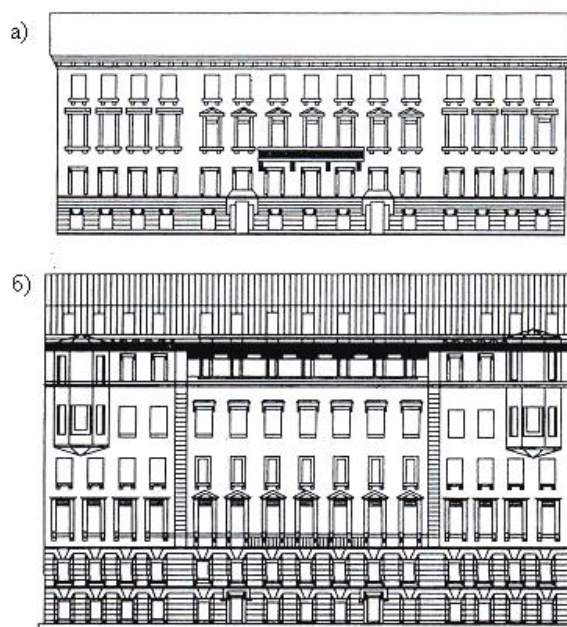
Фасады реконструируемого здания до надстройки (а) и после надстройки (б)
